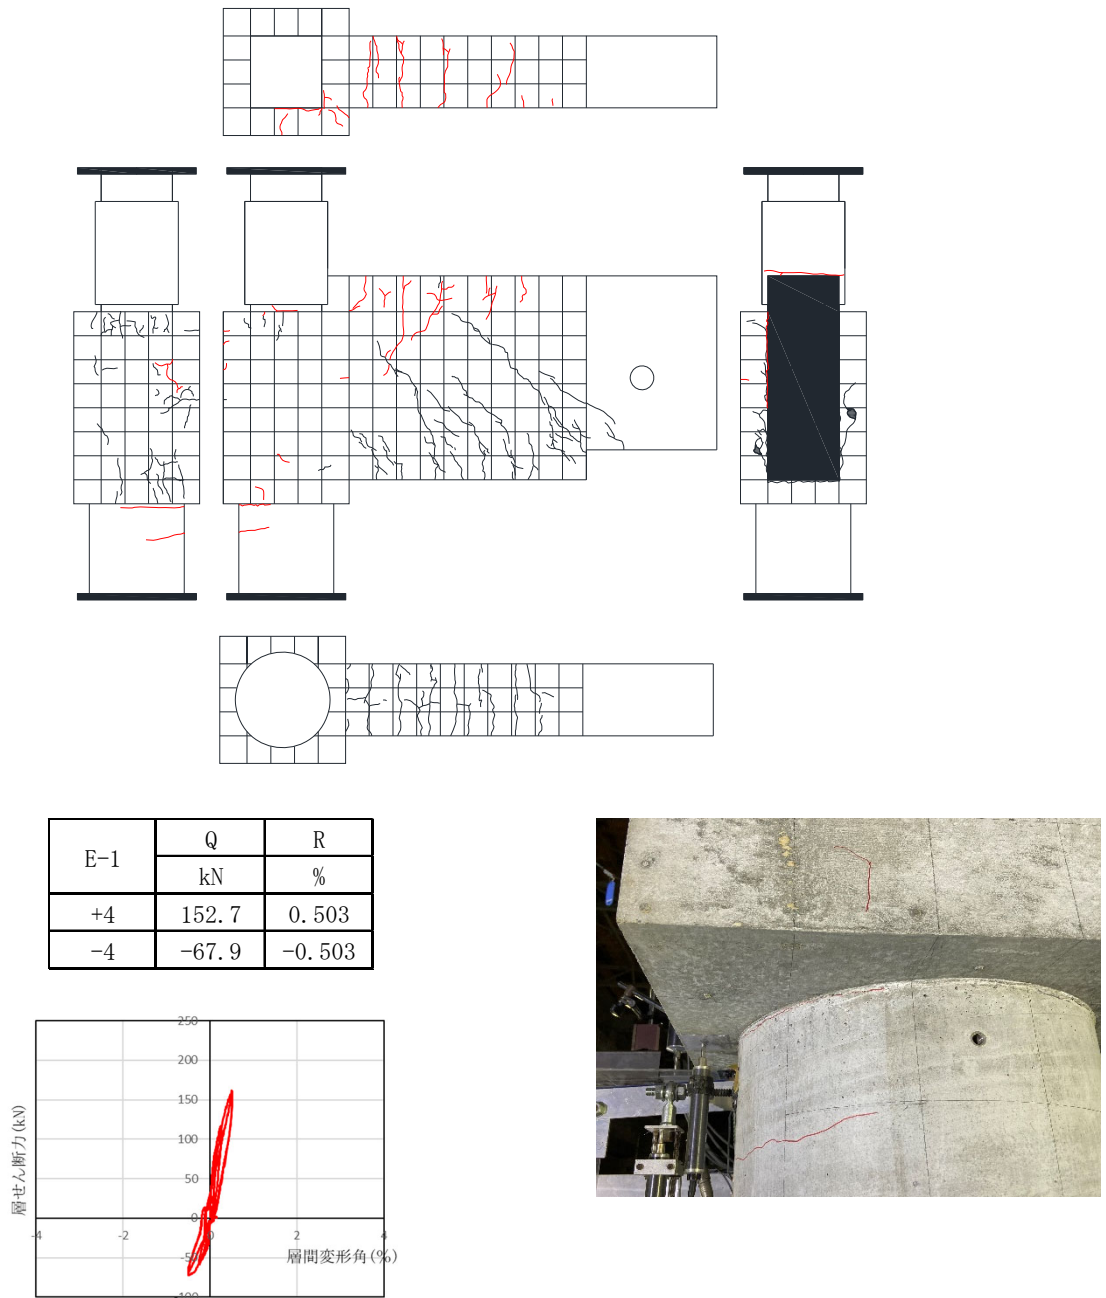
E-1 ひび割れ状況 (1Cycle)
